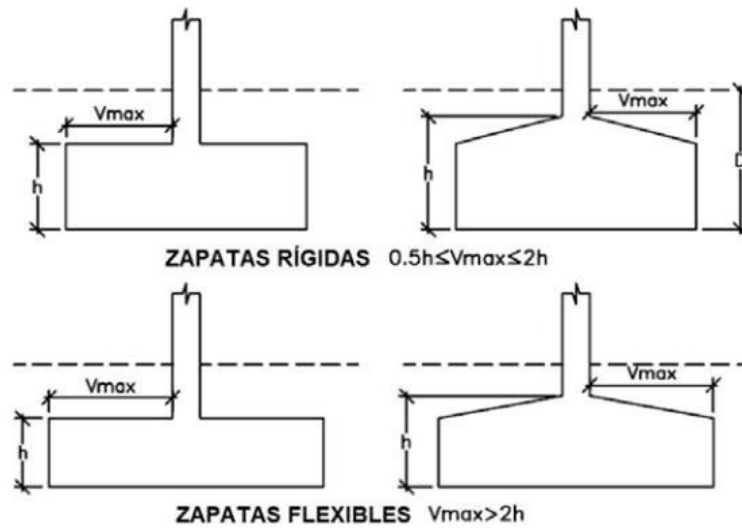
Otra clasificación de zapatas aisladas (rígidas y flexibles)
